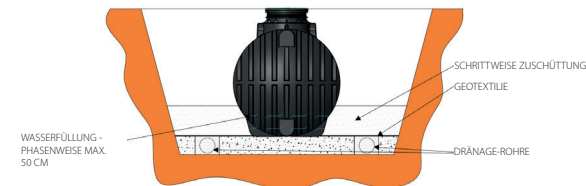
Behältereinbau in schlecht durchlässige Bodenflächen
